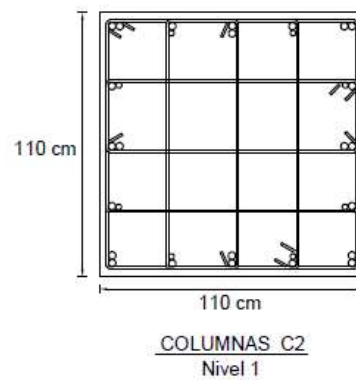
Armado de vigas y columnas diseñadas con las NTCC-04 para el edificio de 6 niveles con un sistema estructural a base de marcos dúctiles y muros diafragma
